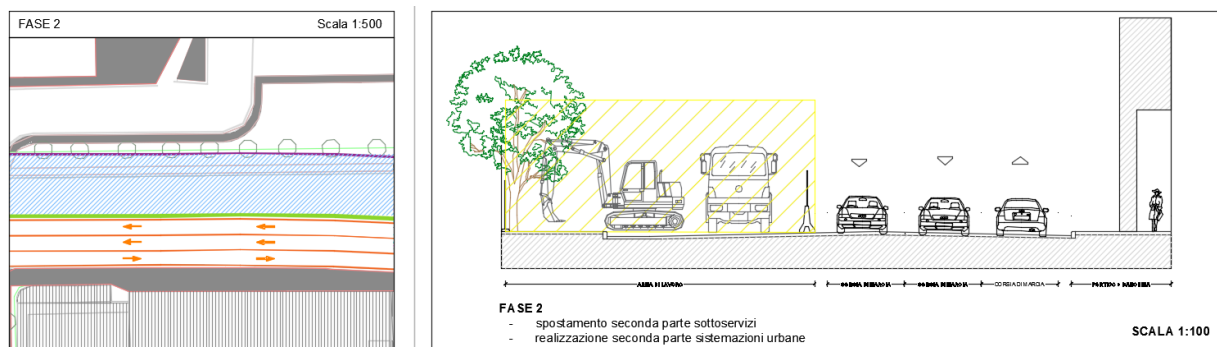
Tipologico cantiere con sede centrale Fase 2
